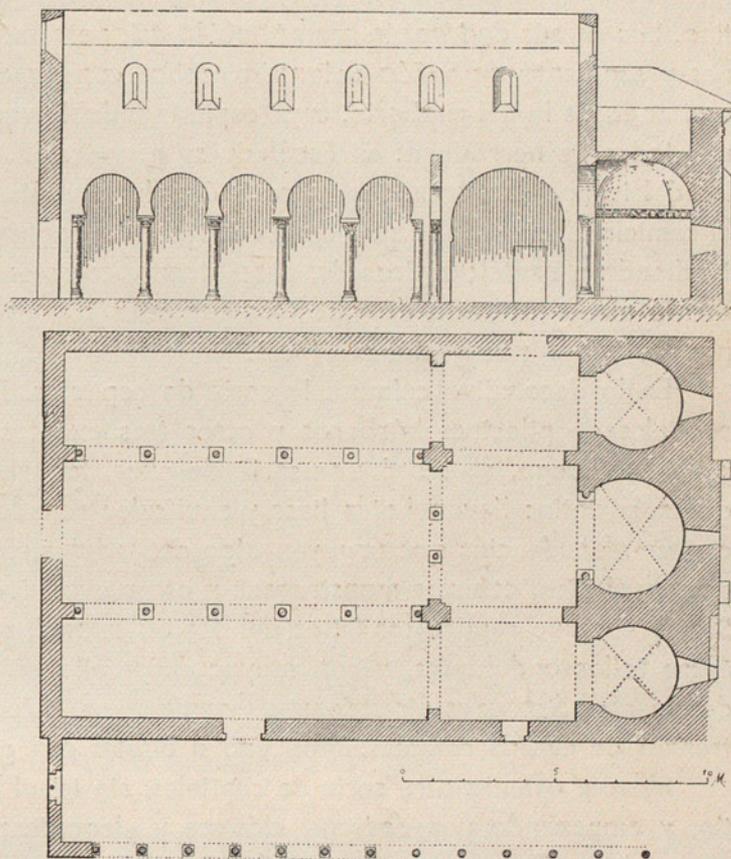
CORTE Y PLANTA DE SAN MIGUEL DE ESCALADA.
